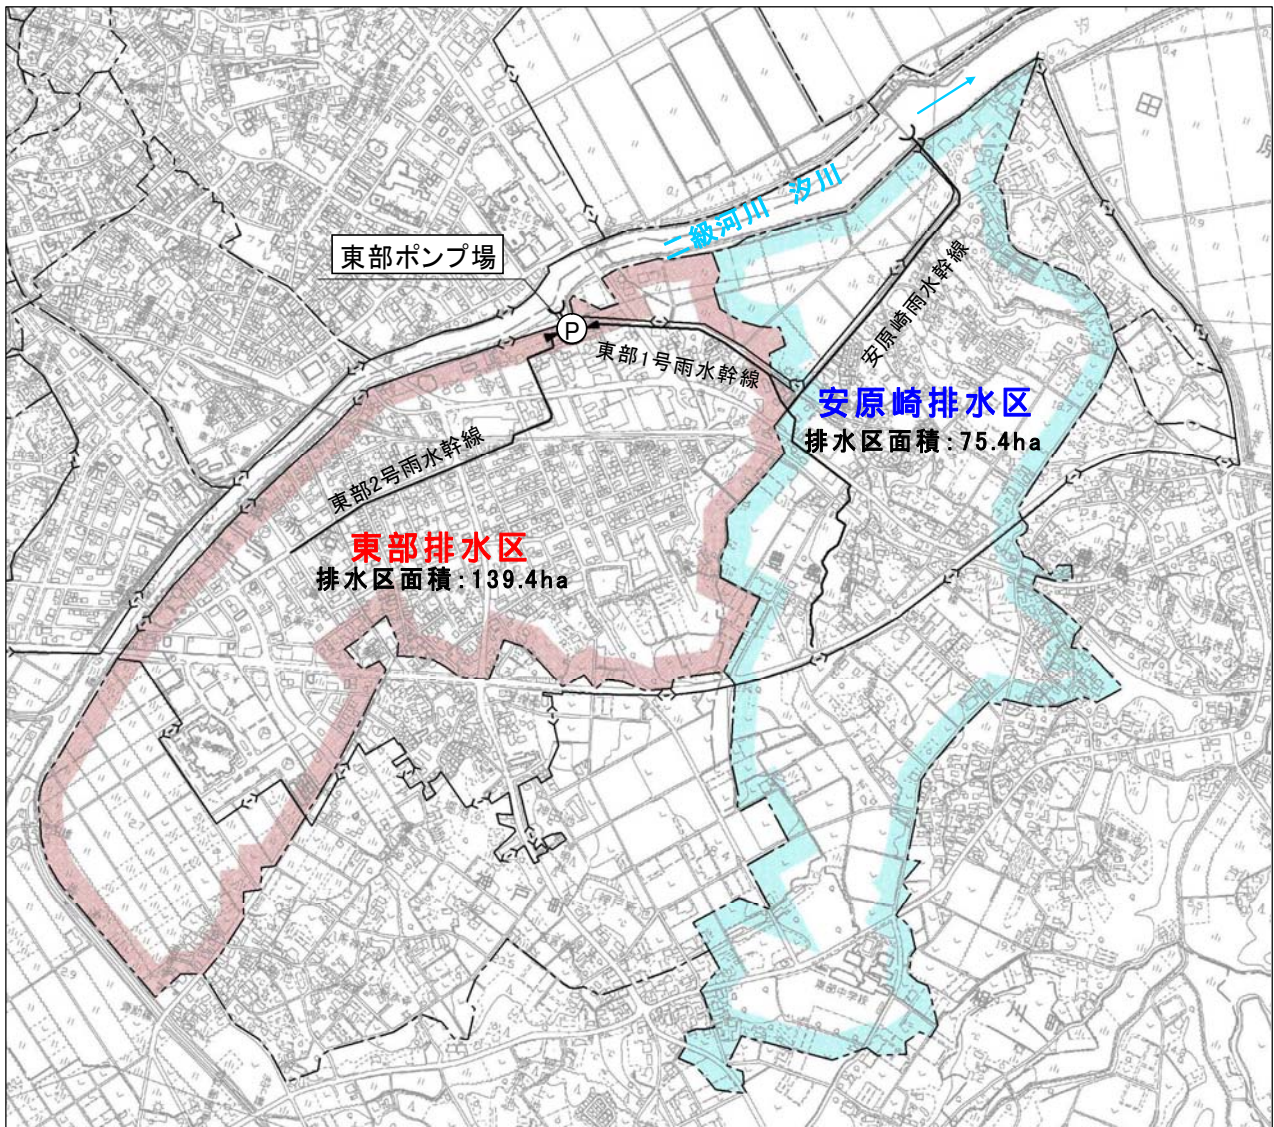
東部排水区及び安原崎排水区計画平面図（雨水）
